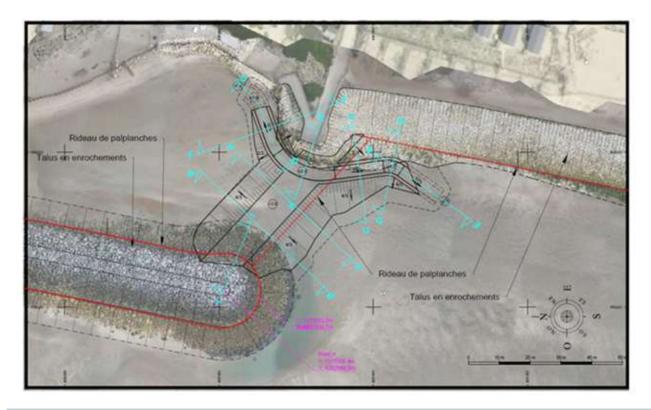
PLAN DE MASSE DES TRAVAUX PROJETES AU STADE PRO AVEC LOCALISATION DES COUPES TECHNIQUES (CREOCEAN, 2022)
